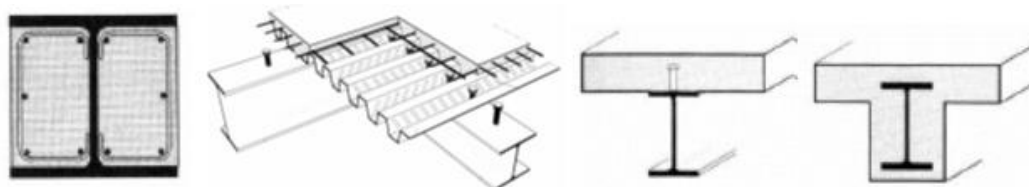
Secções Mistas. Da esquerda para a direita: Pilar Misto, Laje mista com chapa colaborante, Viga Mista com conectores, Viga mista totalmente embebida (Simões, 2014)
